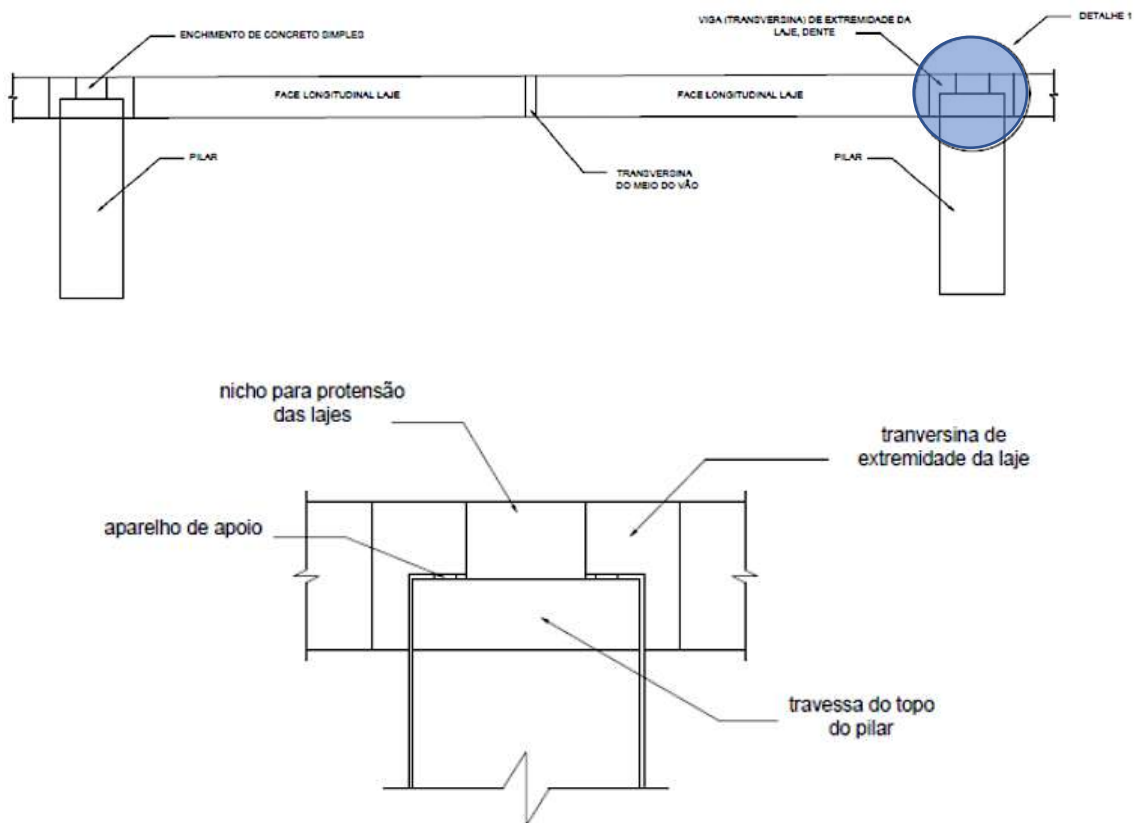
Corte da estrutura do viaduto antes do Retrofit, detalhamento do pilar e da face longitudinal da laje protendida. Fonte: Adaptado de Novacap, 2018
